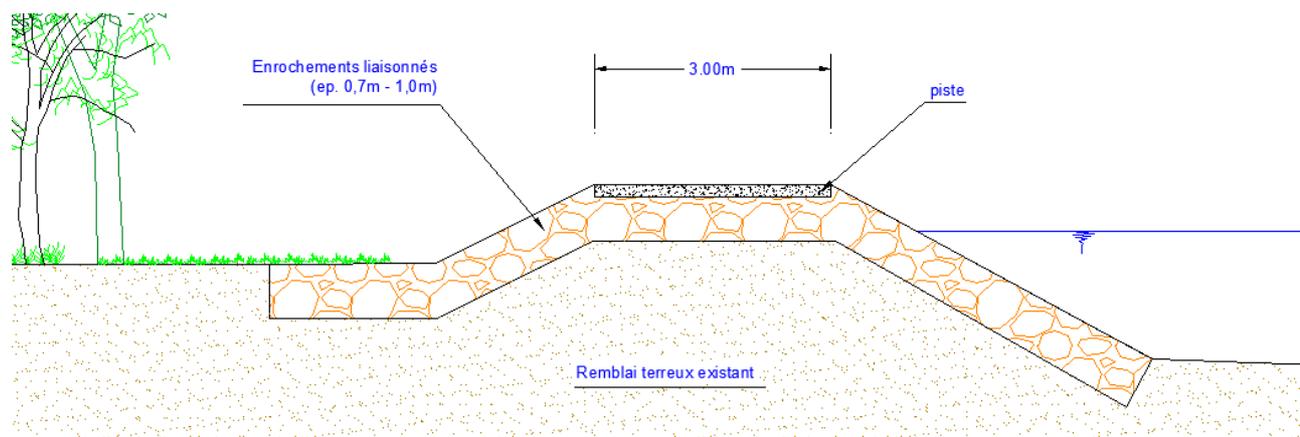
Coupe de principe de la protection de digue au droit des déversoirs
